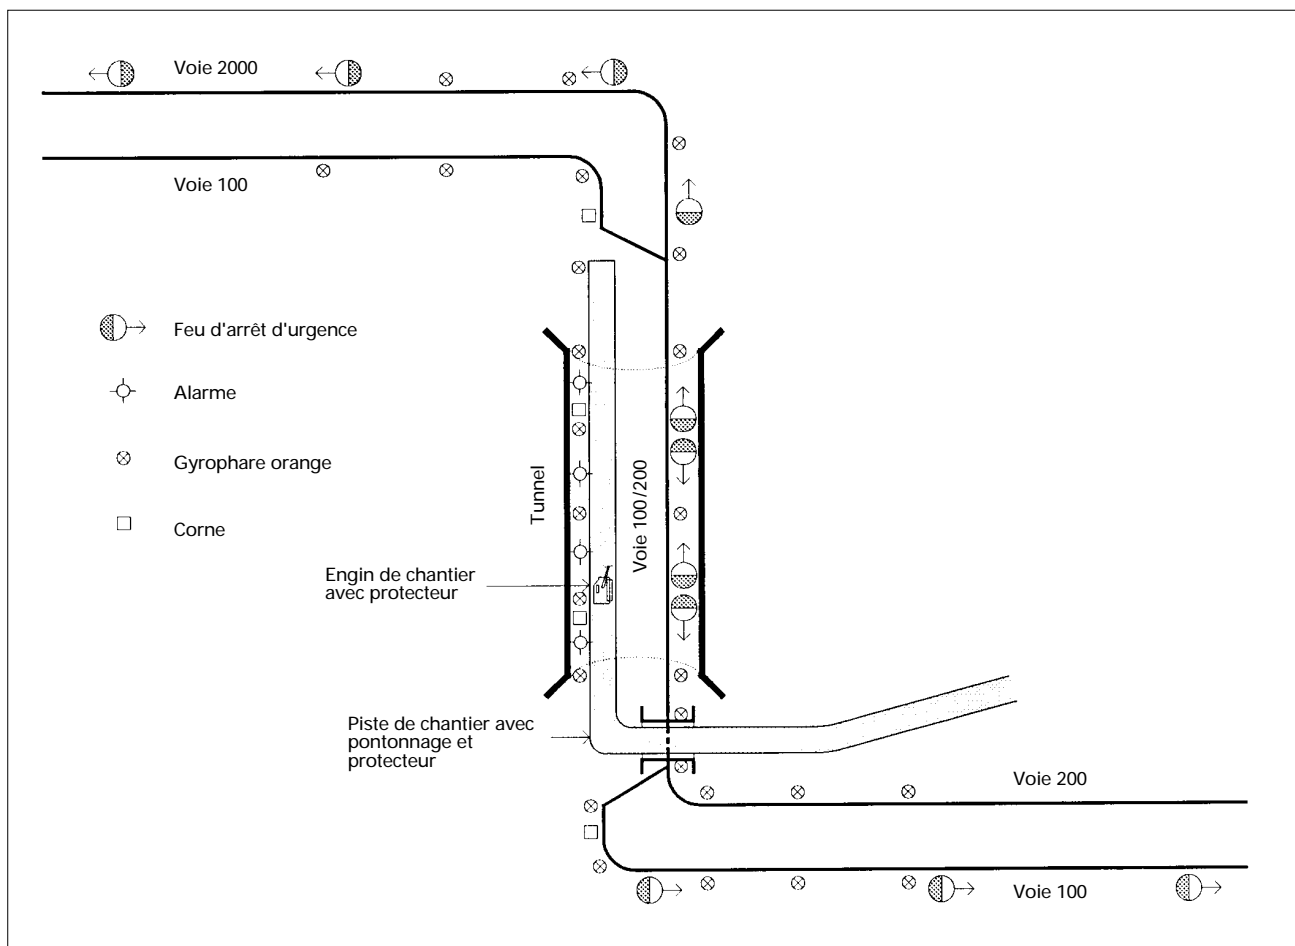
Tunnel CFF du Rohr bach. Organisation du chantier et installations de sécurité (créneau d'entretien Type VI)
